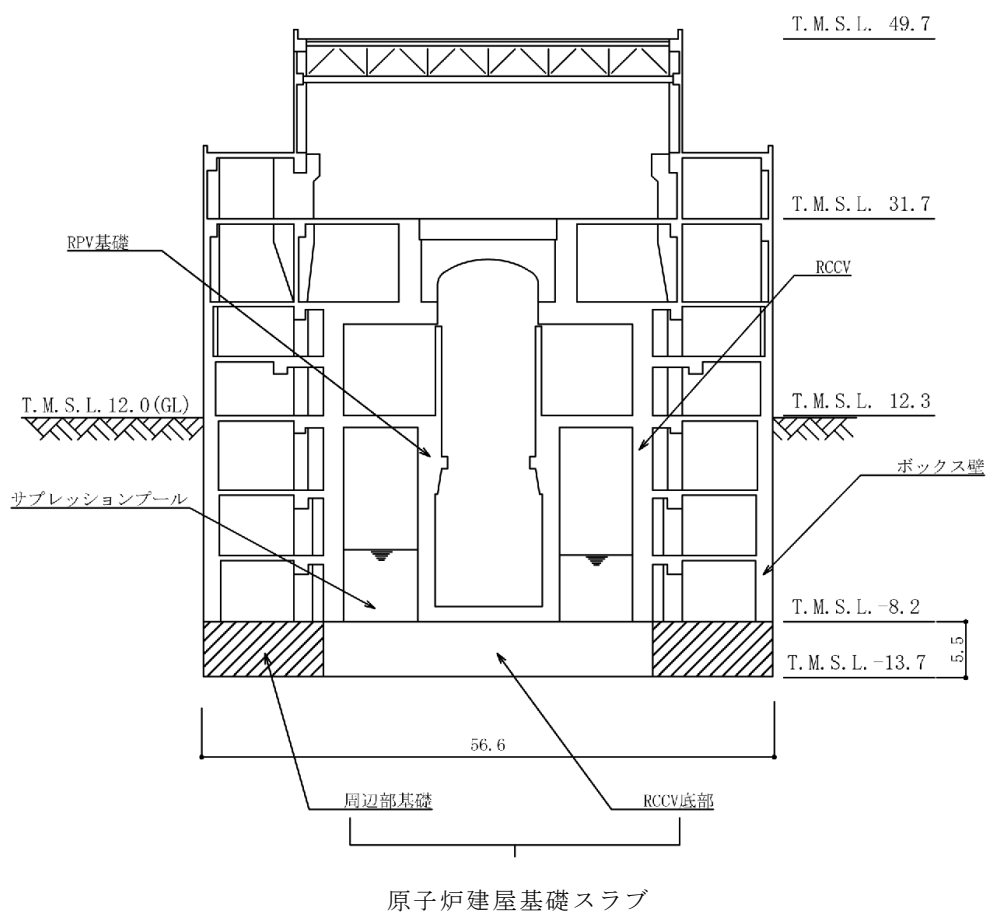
原子炉建屋基礎スラブの概略断面図 (A-A 断面) (単位 : m)
